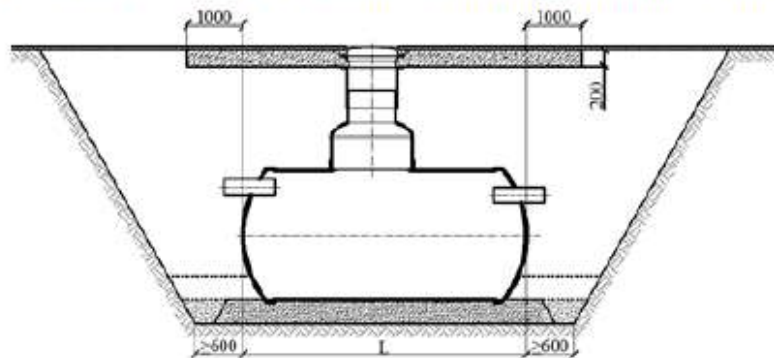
Схема расположения горизонтального корпуса в зоне наезда транспорта с низким уровнем грунтовых вод
